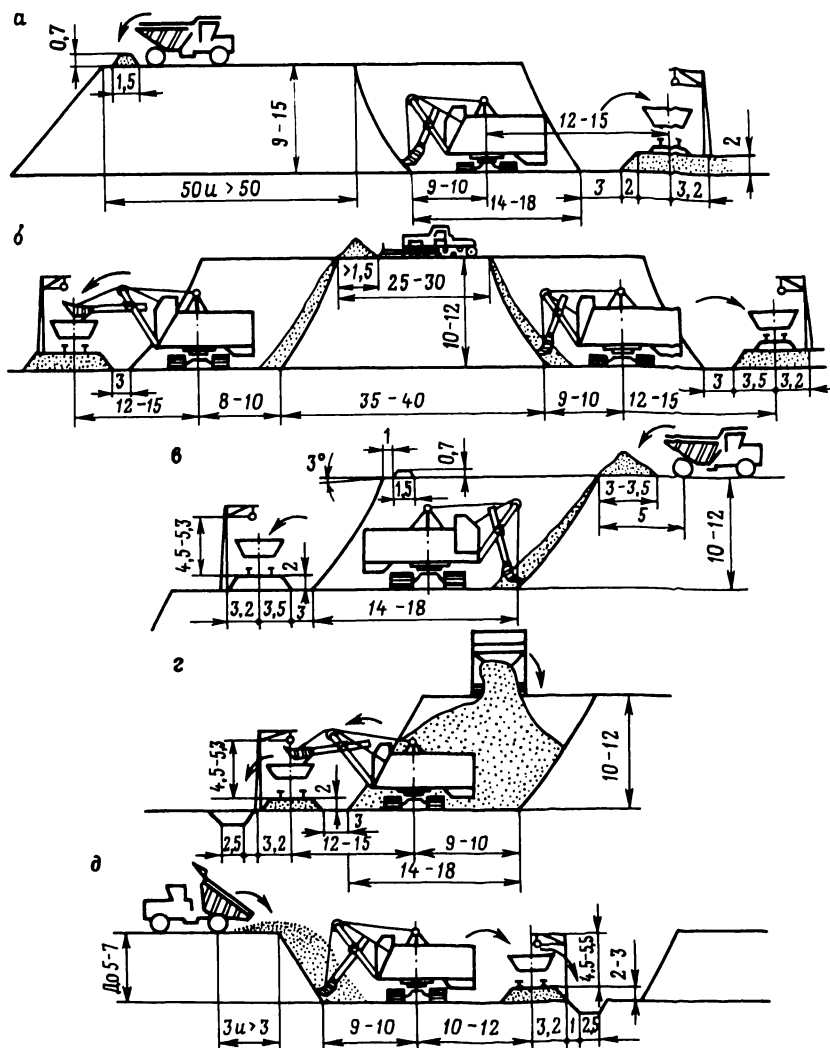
Схемы наиболее распространенных карьерных перегрузочных складов: а — штабельный односторонний; б — штабельный двусторонний; в — бортовой фронтальный; г — бортовой торцовый; д — заглубленный
